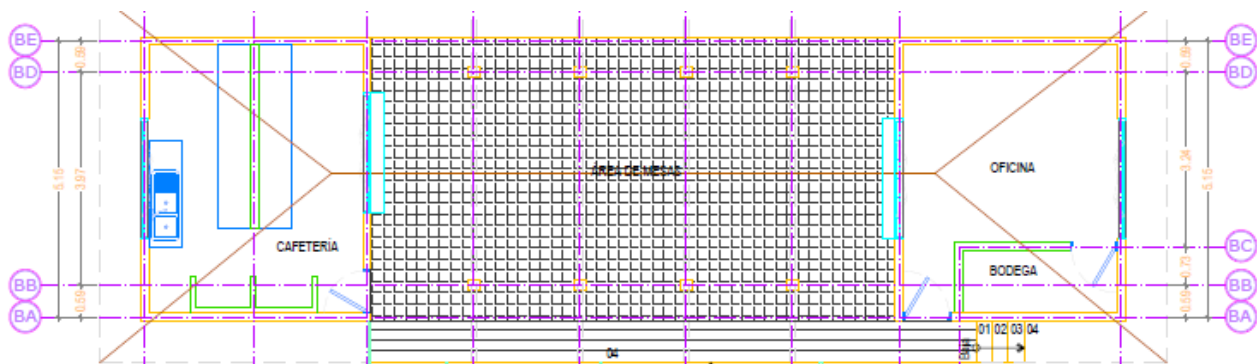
Planta el edificio cafetería y oficina, Parque Los Naranjos, Lago de Yojoa
